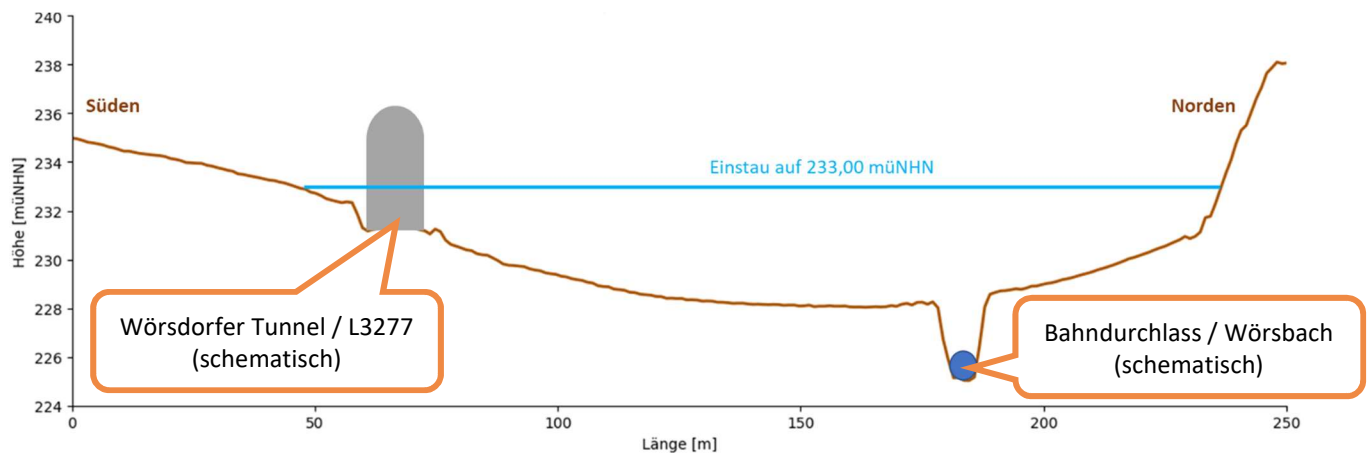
Geländeschnitt vor dem Bahndamm mit Wörsdorfer Tunnel und Bahndurchlass bei einer Einstauhöhe von 233,00 müNNH (Abbildung überhöht)
